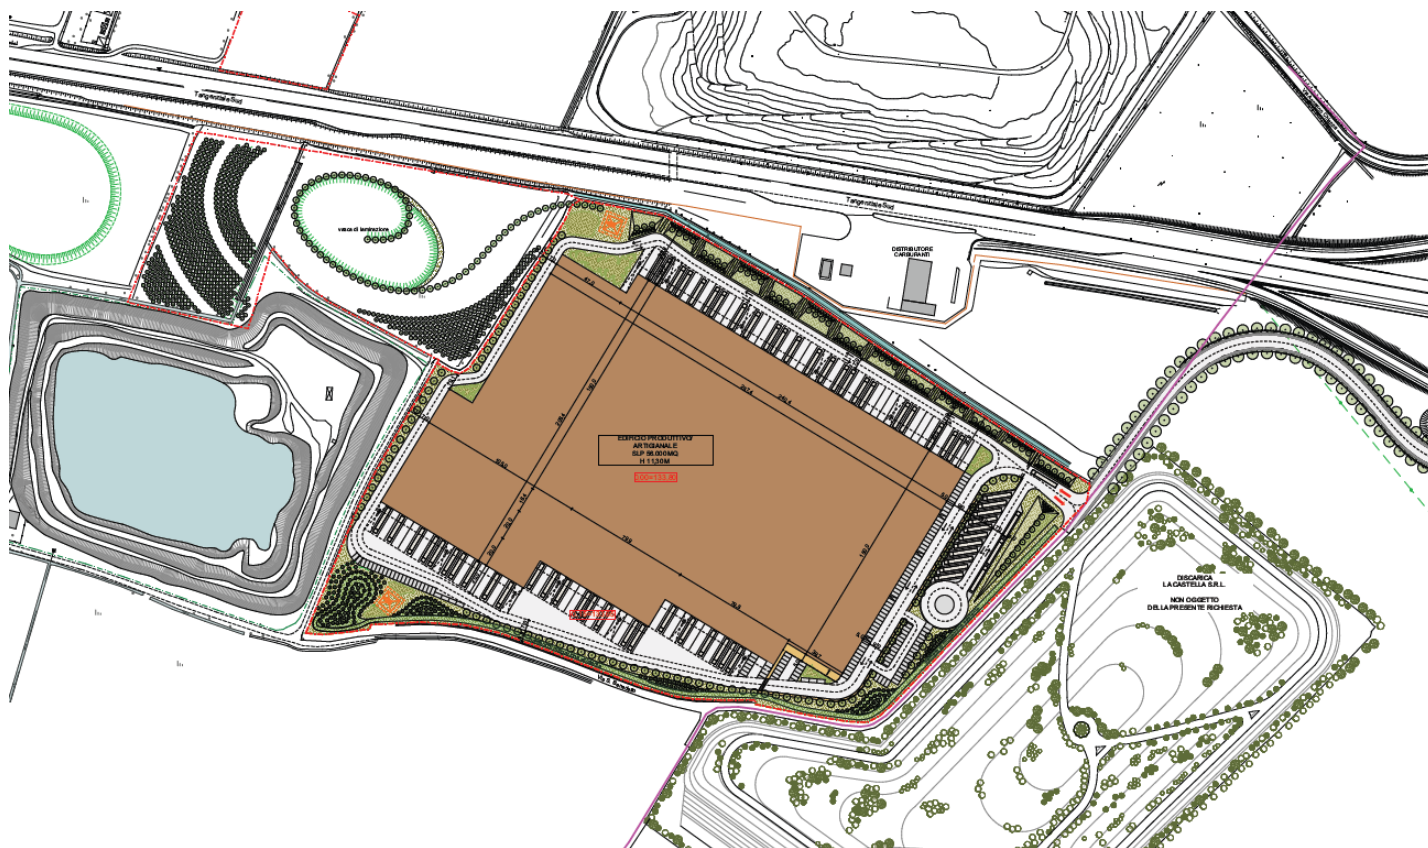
Planimetria nuovo centro logistico – Lotto 2 - Area PAV – SUAP – ATE g25
